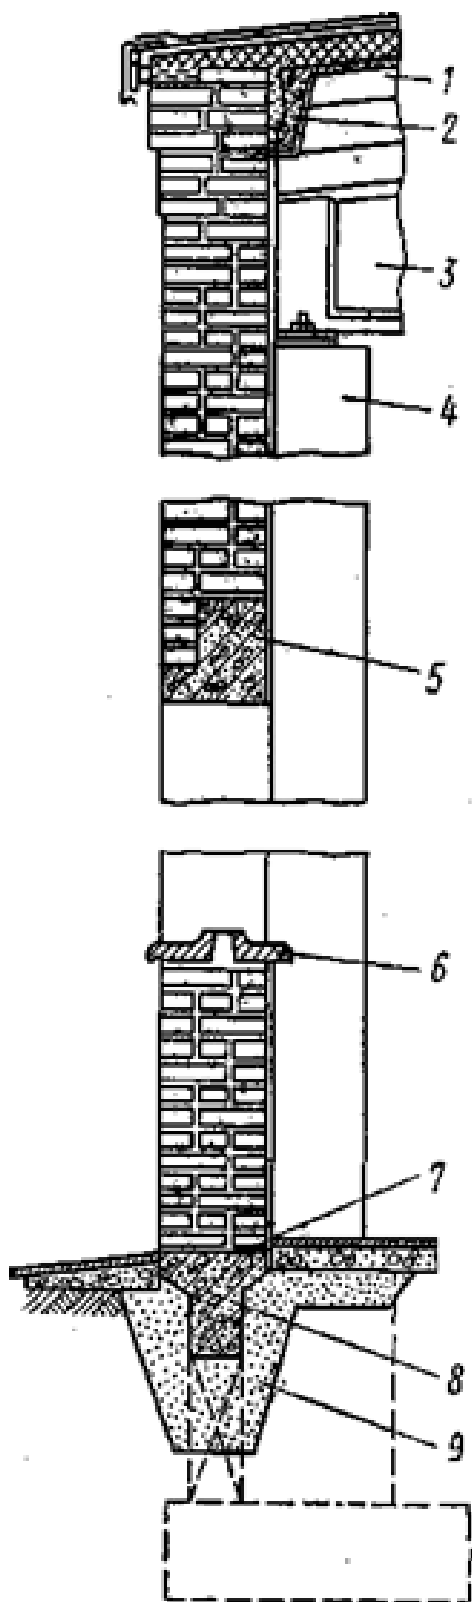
Разрез кирпичной стены каркасного большепролетного здания:
